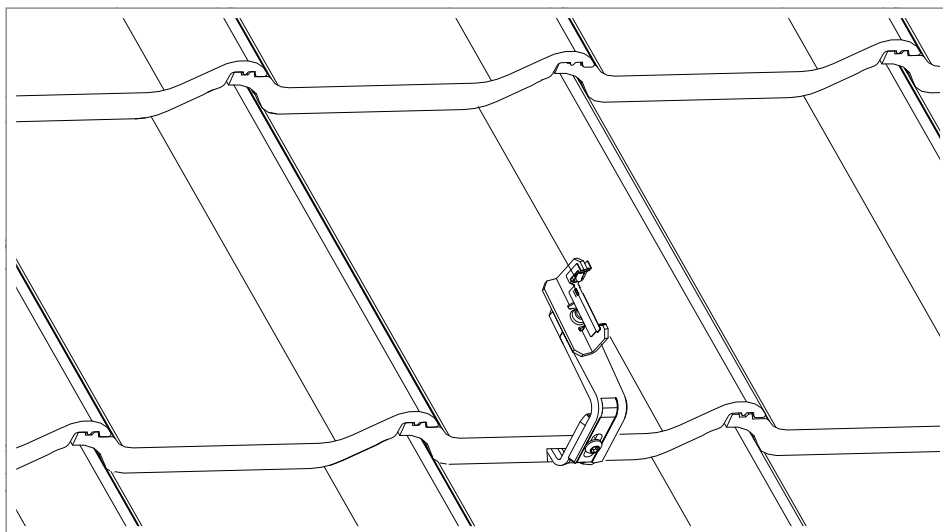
Rebaixar o lado inferior da telha sobreposta
